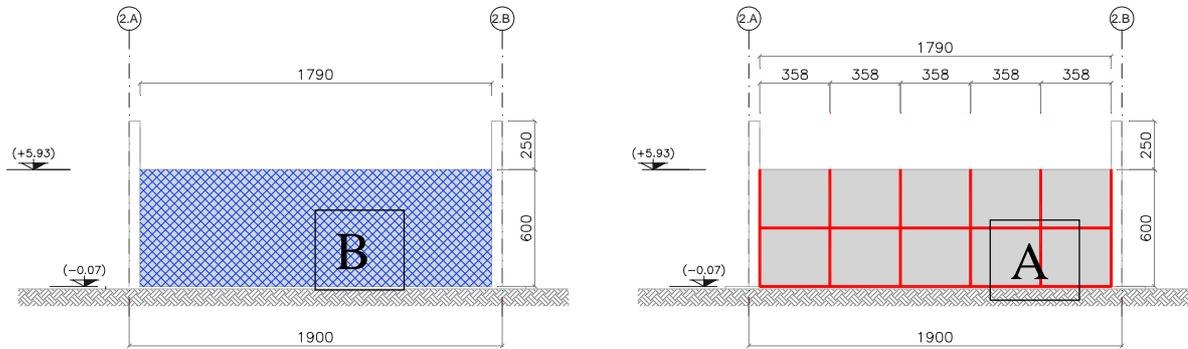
Demolizione e rimozione opere civili fuori terra- Prospetto sud
